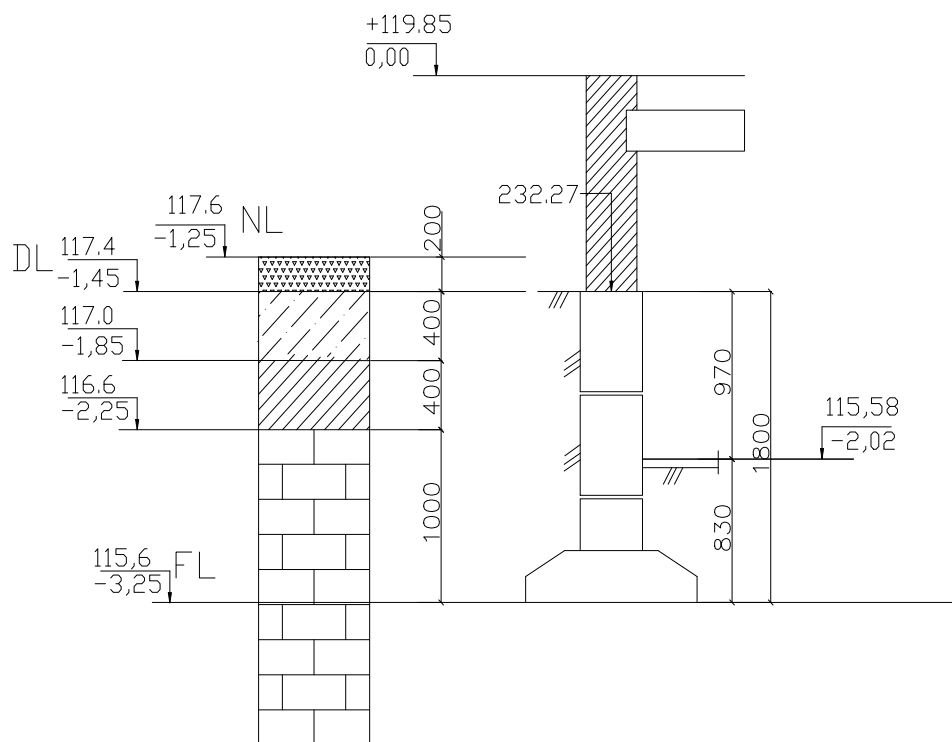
Расчетная схема к расчету 1-го сечения
